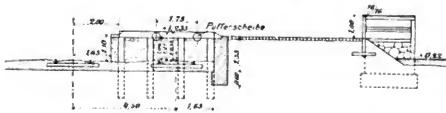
Grundriß einer zweistöckigen Laderampe. M. 1 : 1000.
